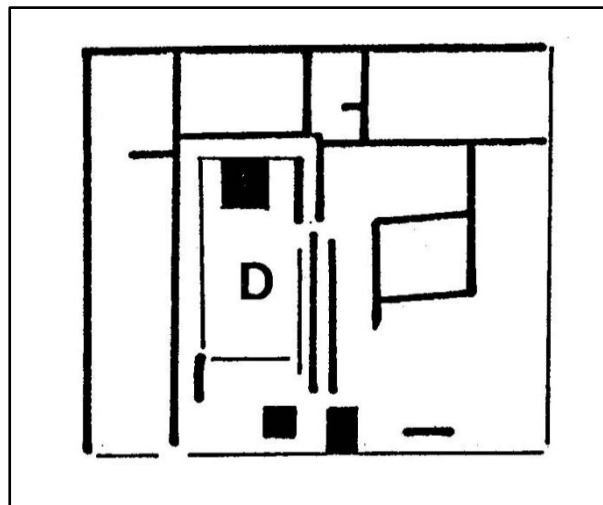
Schematisierter Grundriss des Gebäudes C-2 der 2. Kastellphase nach dem „Gesamtplan Bersu“ von 1914 (vgl. Abb. 8), Gebäudemaße ca. 22 x 27 m.
